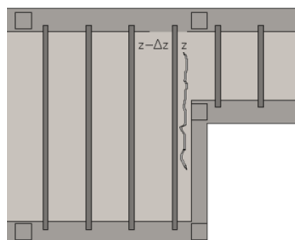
Fisuración en cara inferior de forjado por cambio de rigidez de viguetas
